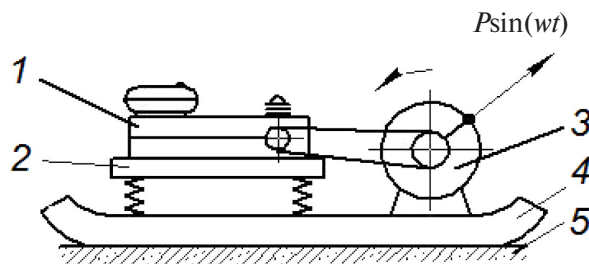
Виброуплотнитель с вибратором ненаправленного действия: 1 – приводной двигатель; 2 – подрессоренная рама; 3 – вибратор ненаправленного действия; 4 – рабочая плита; 5 – уплотняемый материал
